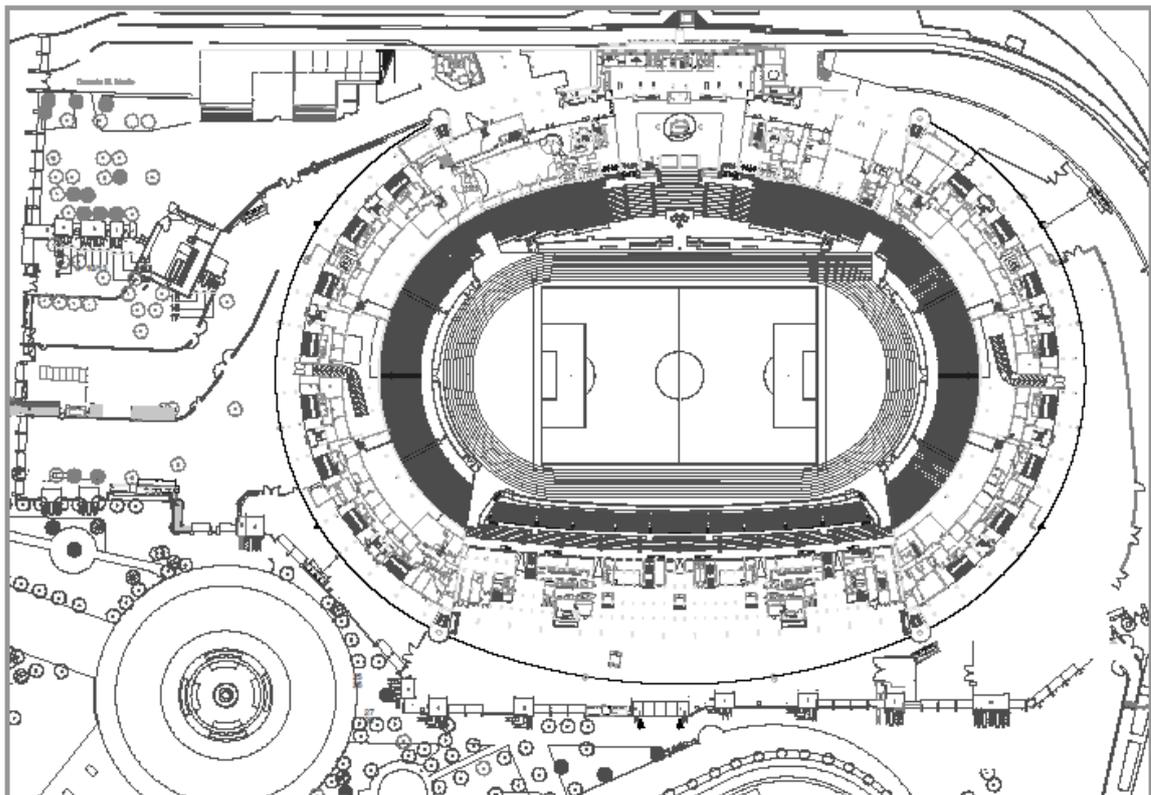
Planimetria Piano Terra Stadio Olimpico
